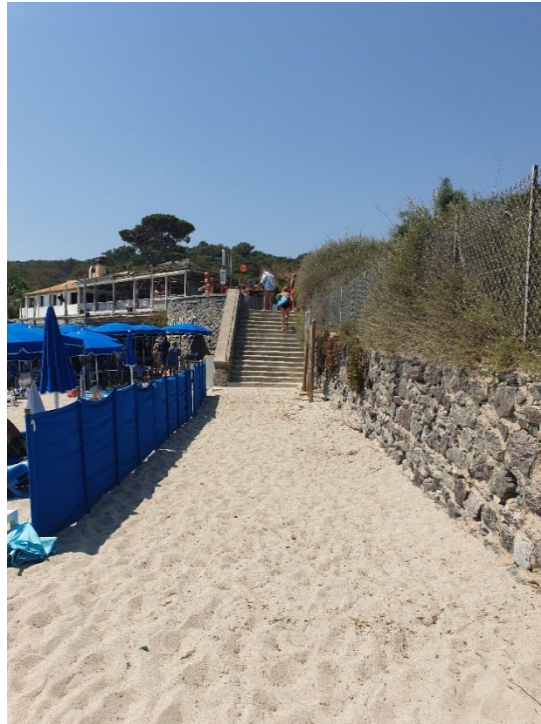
Escalier d'accès à la plage où sera situé le lot 5
